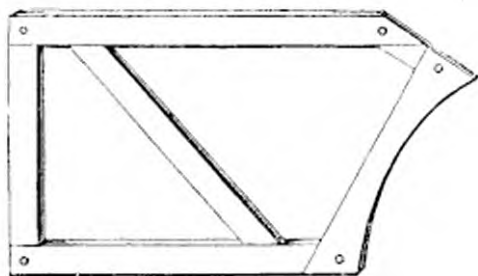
Panneau servant à faire le tracé sur la pierre.
